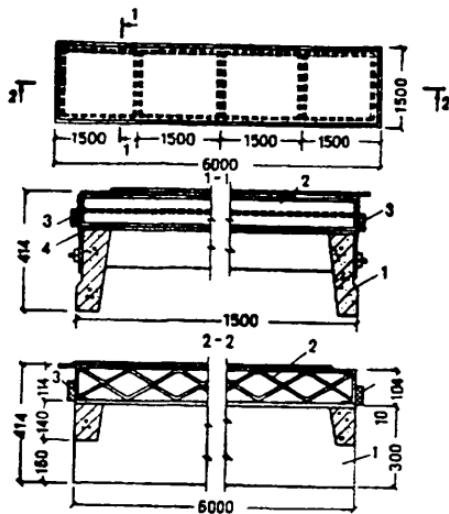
Конструкция светопрозрачной панели с железобетонной несущей рамой и световой плитой из стеклопластика:
